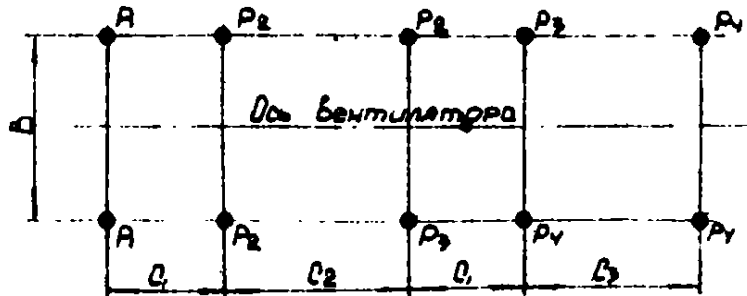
Схема распределения нагрузки на опоры осевого вентилятора двухстороннего всасывания типа ВВД-40
